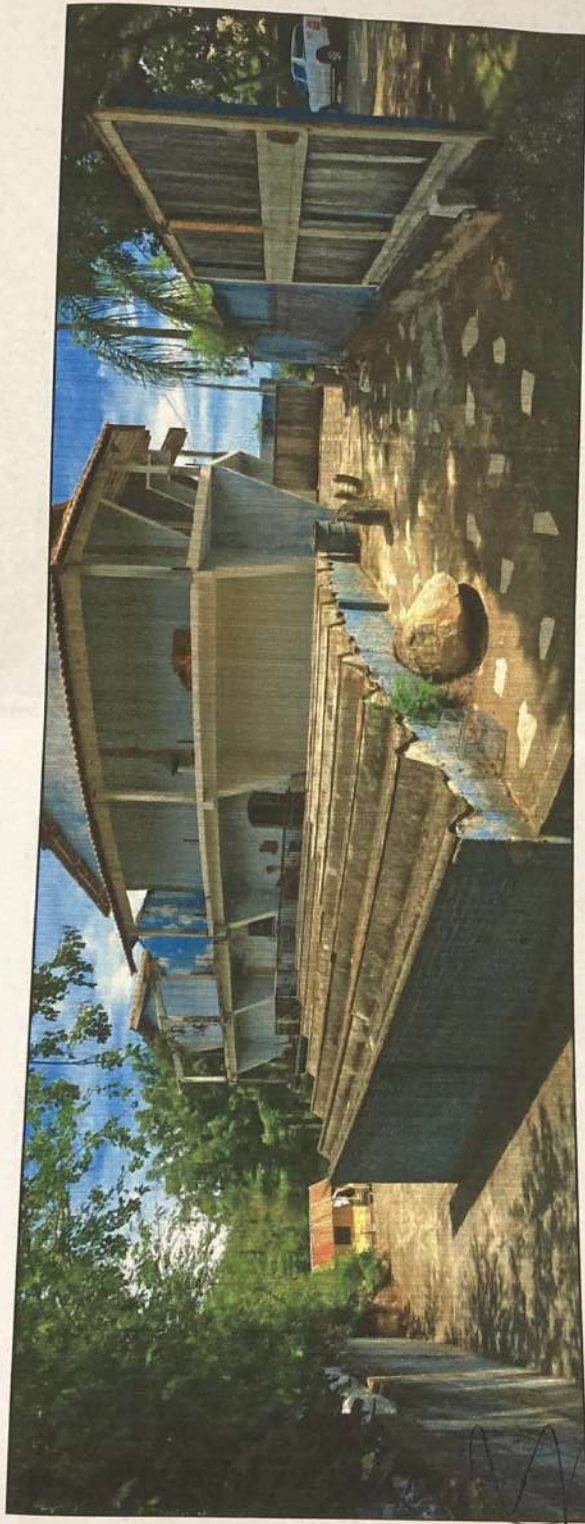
Panorâmica do interior do sub judice, olhando em direção à divisa aberta com a casa 317
